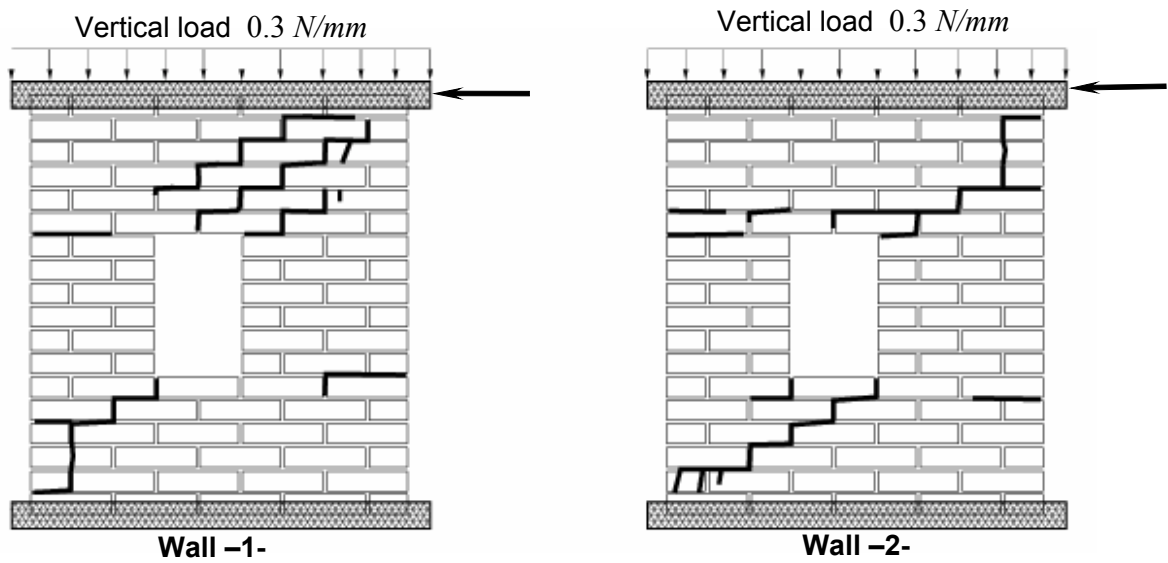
Dos muros de mampostería fracturados bajo carga de cortante.
